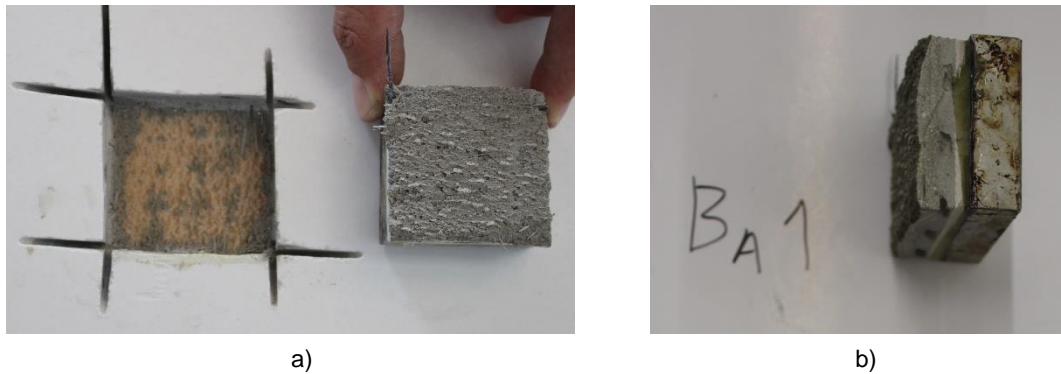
Ensaio de aderência Ba₁: a) Vista de frente; b) Vista em perfil
